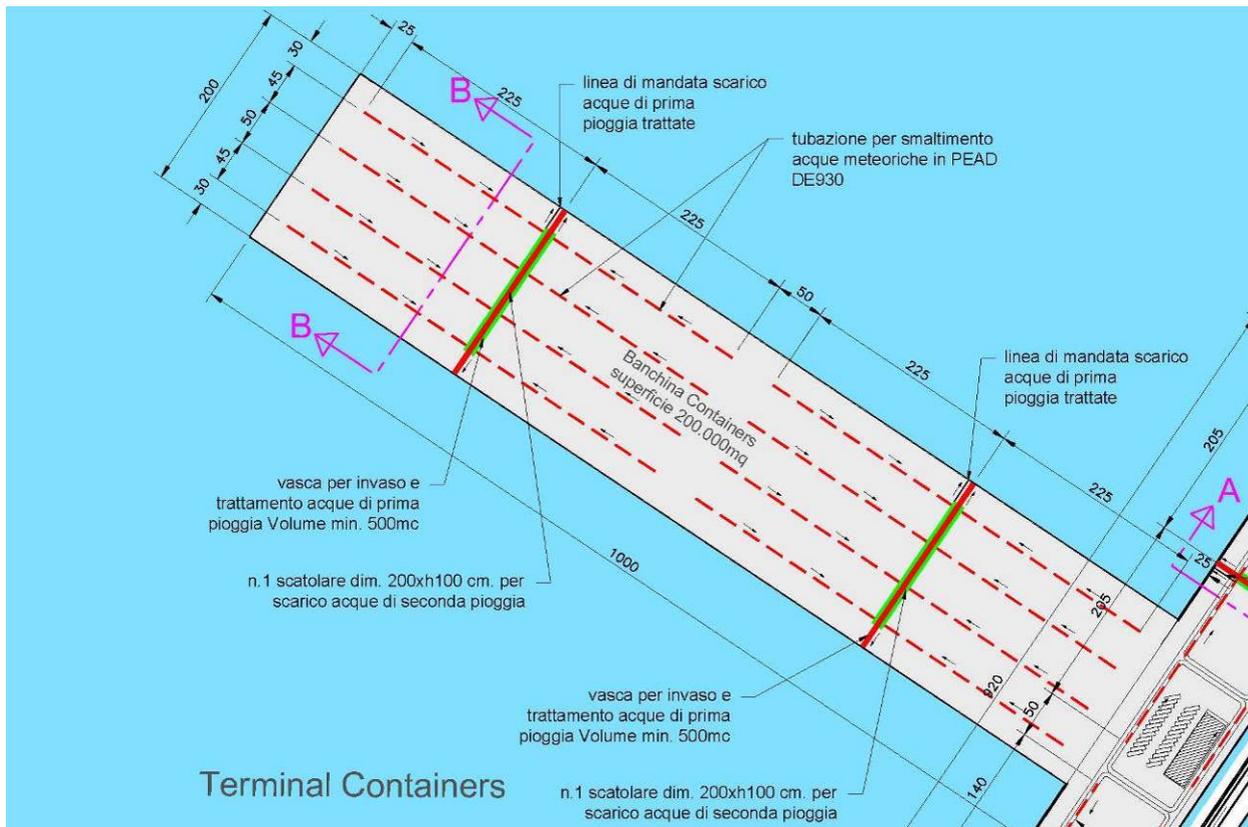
Banchina container – planimetria rete di smaltimento acque meteoriche.
